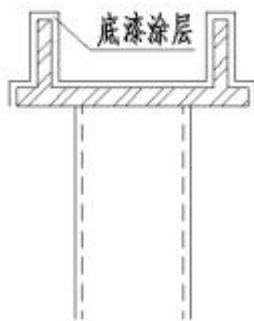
钢与混凝土接触面（钢混组合桥梁）示意图
